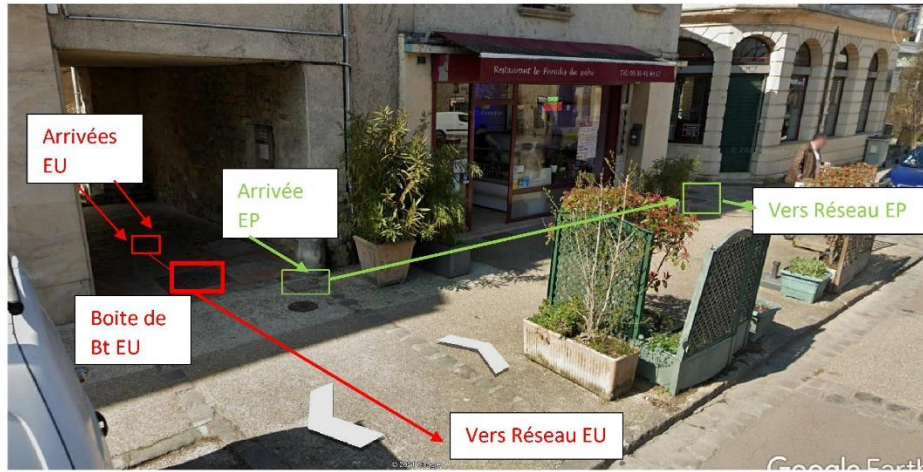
Avenue Clemenceau, au débouché de la Place de l'Église
